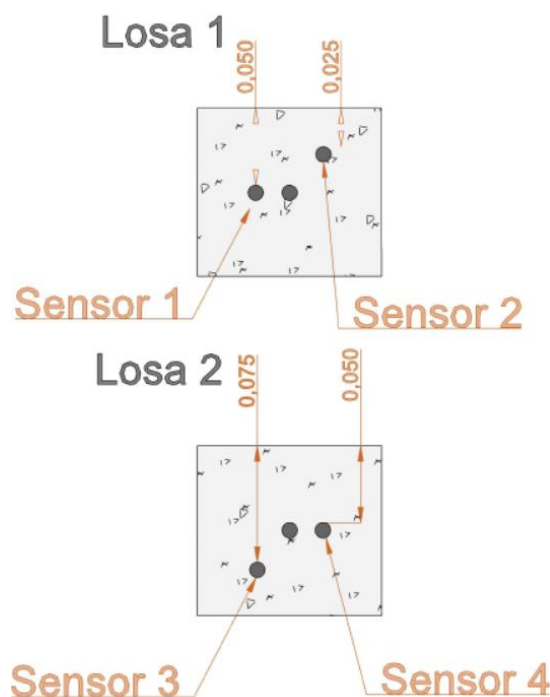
Configuración sensores. Losa 1, S1 y S2, losa 2, S3 y S4
